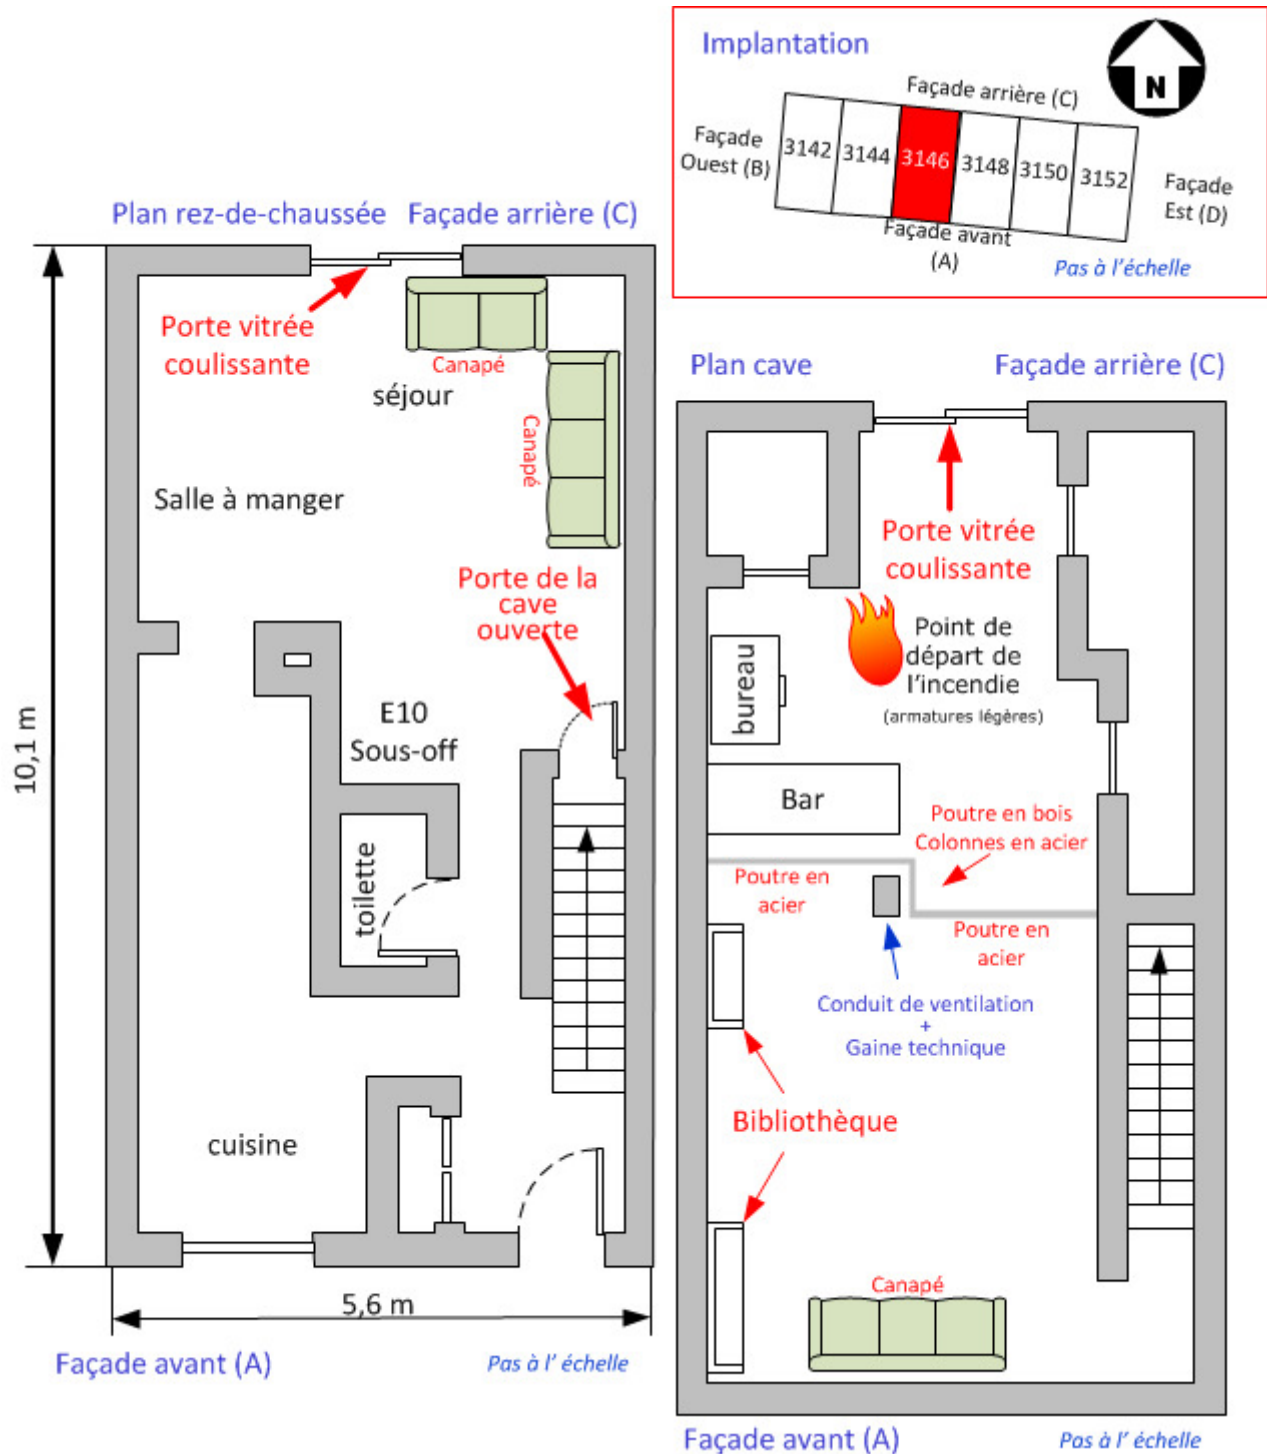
Plans du rez-de-chaussée et de la cave.
